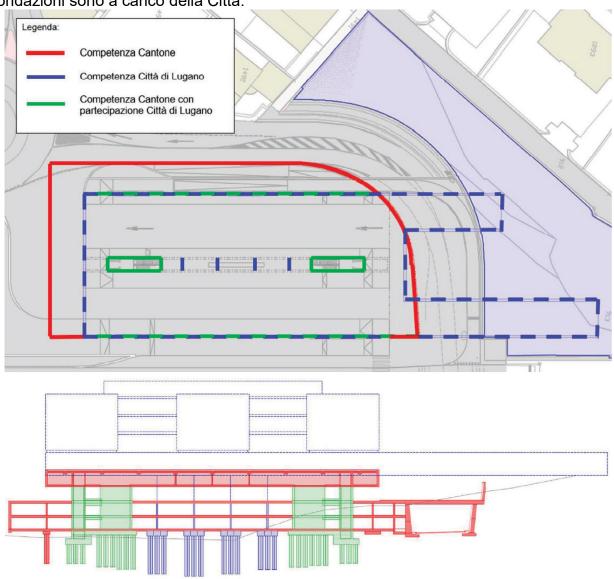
Limiti di progetto copertura, pianta (sopra) e sezione (sotto)
